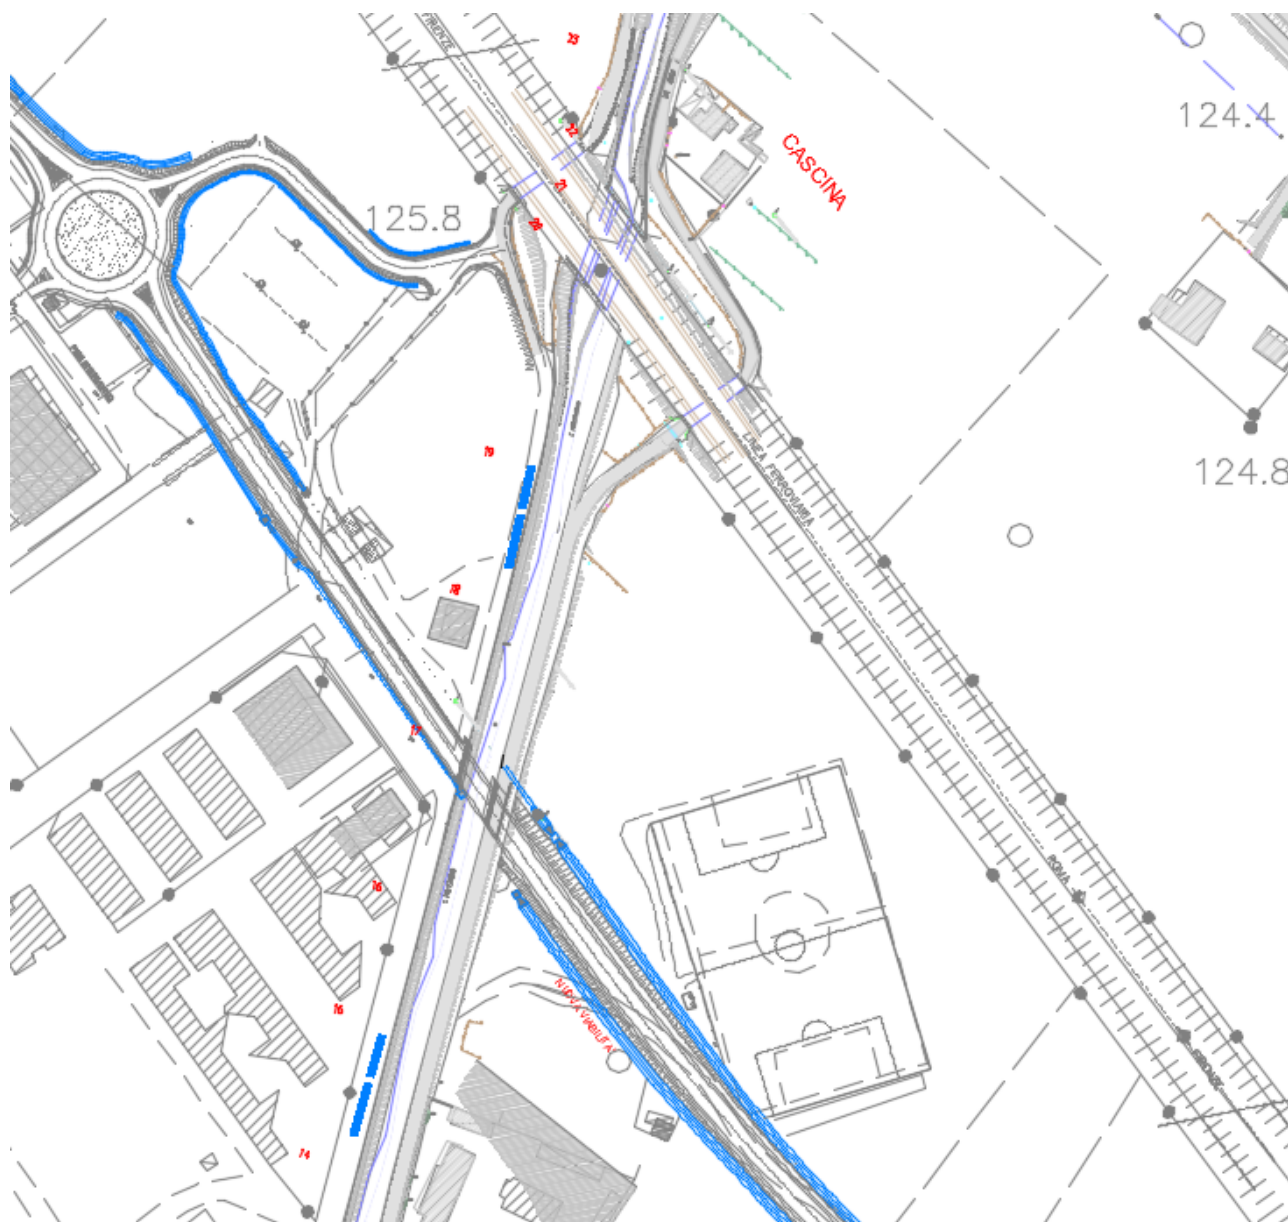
Interventi previsti nel Progetto della cassa di espansione di Restone
